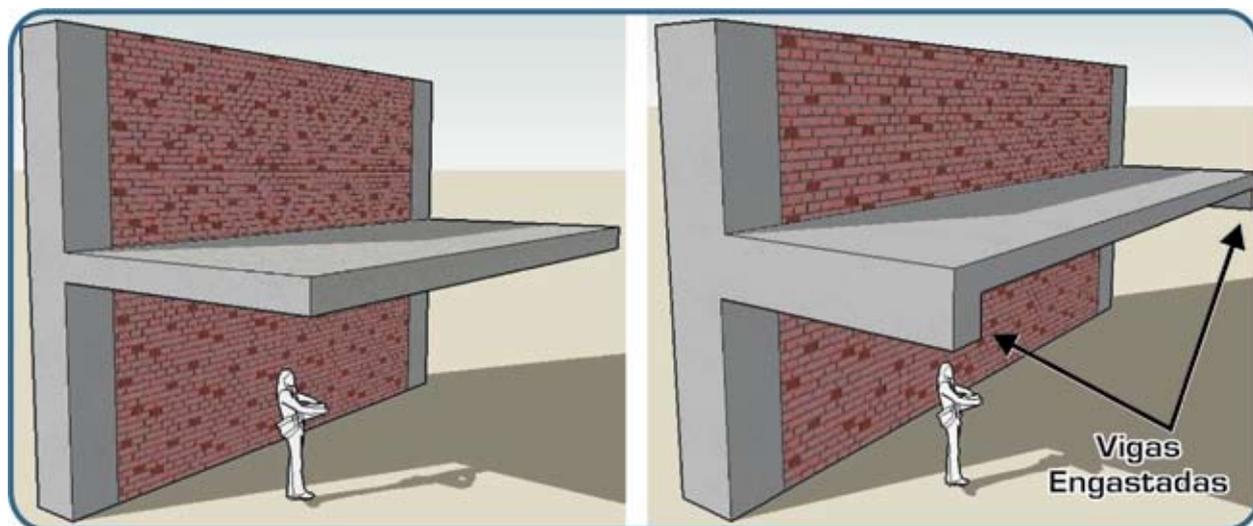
Dois tipos de sistemas estruturais de marquises. (a) laje diretamente engastada; (b) laje apoiada sobre vigas engastadas.
